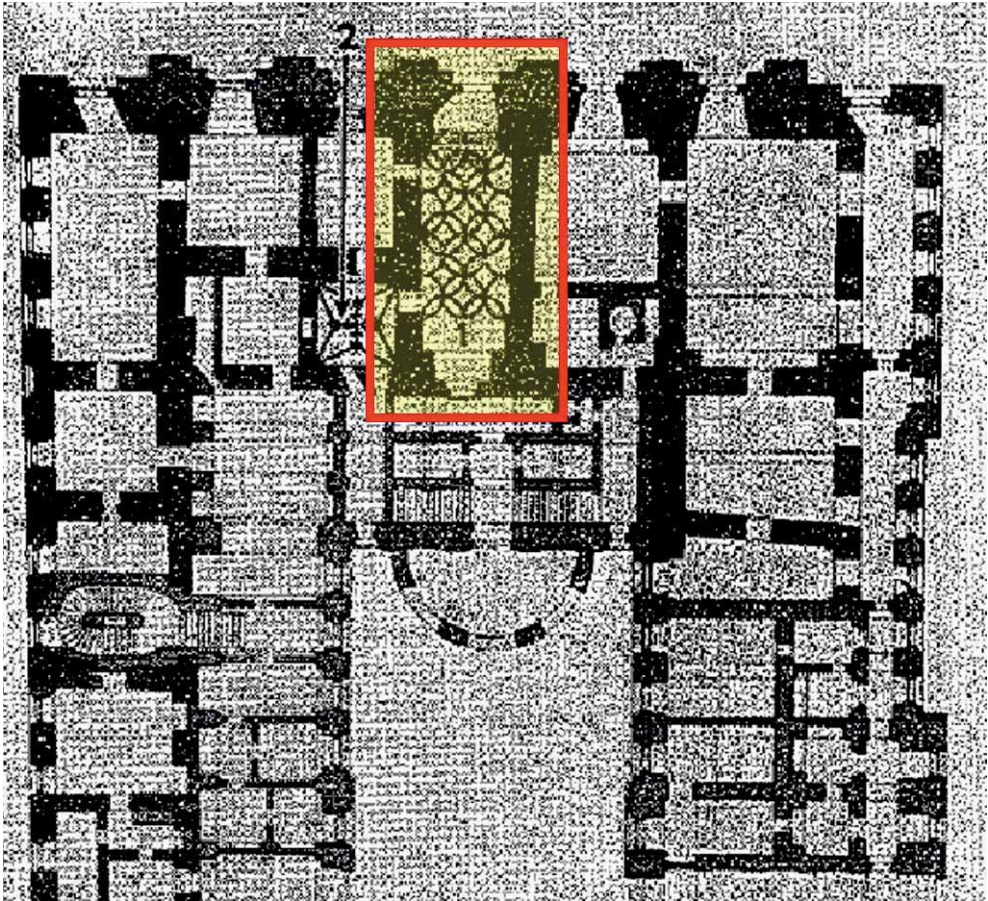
Grundriss des Erweiterungsbaues Niederösterreichisches Palais mit dem Schlingrippengewölbe im Erdgeschoss (oben mitte) in der ehemaligen Kutschdurchfahrt – nach Erweiterung zum Palais Niederösterreich dann Landhauskapelle
